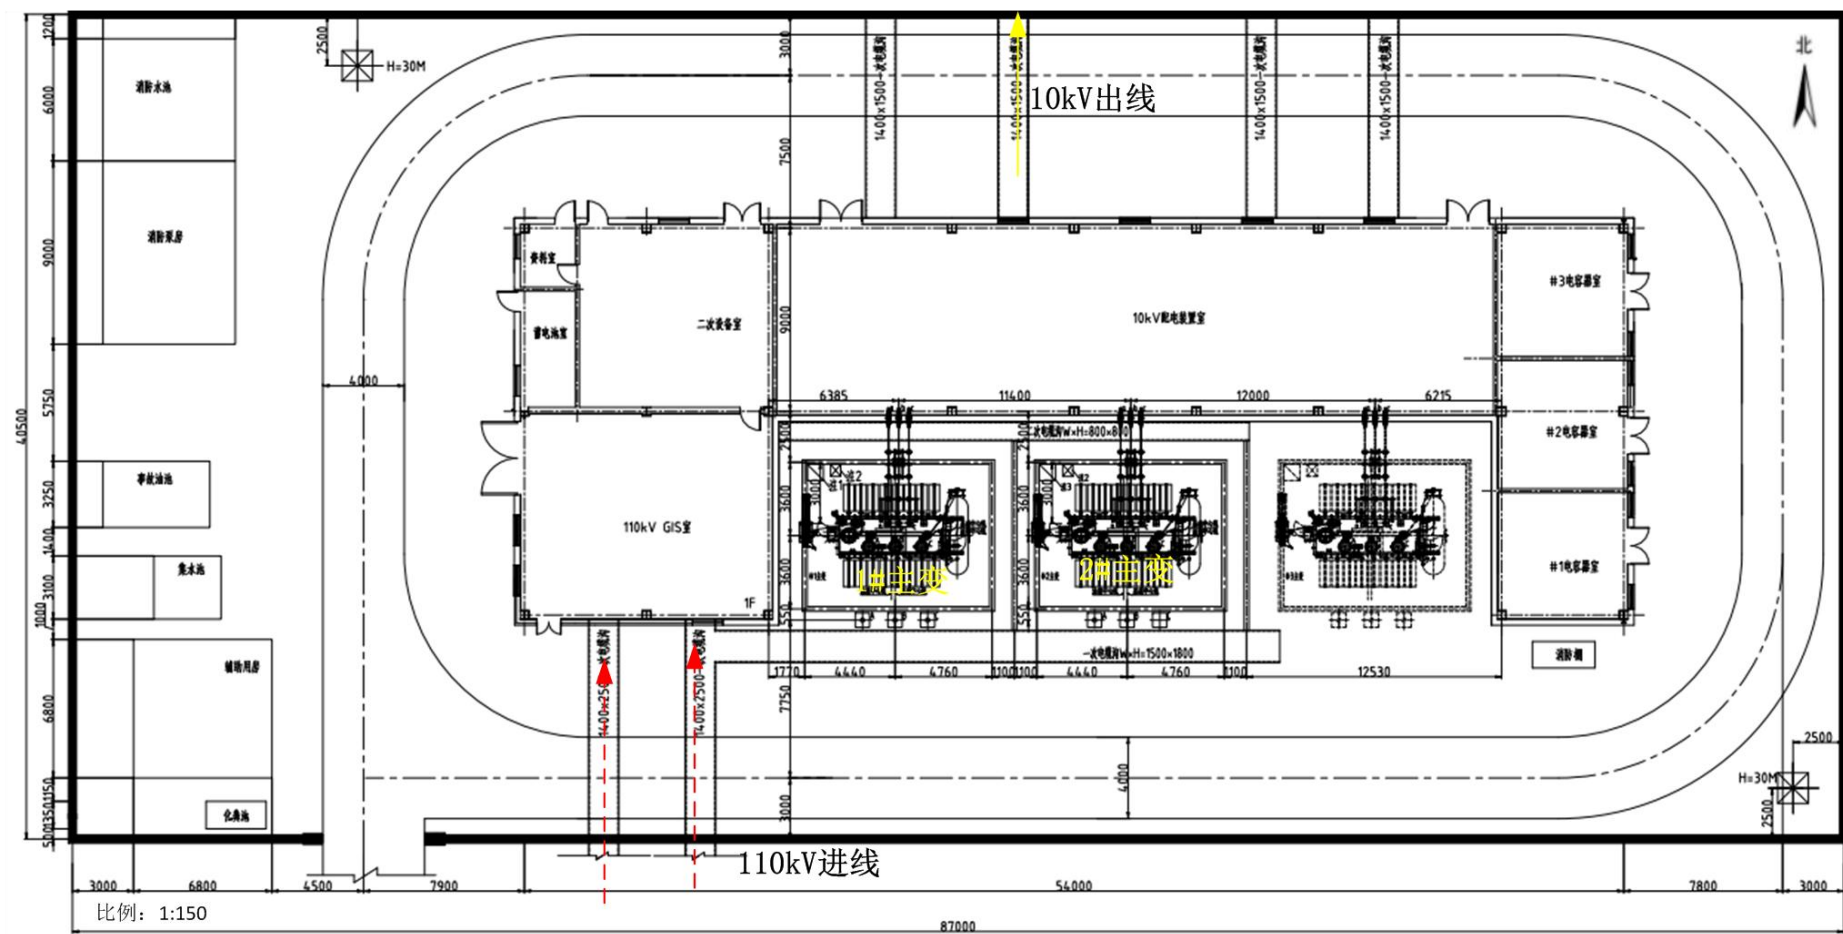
泰安新泰汶康 110kV 变电站平面布置图
